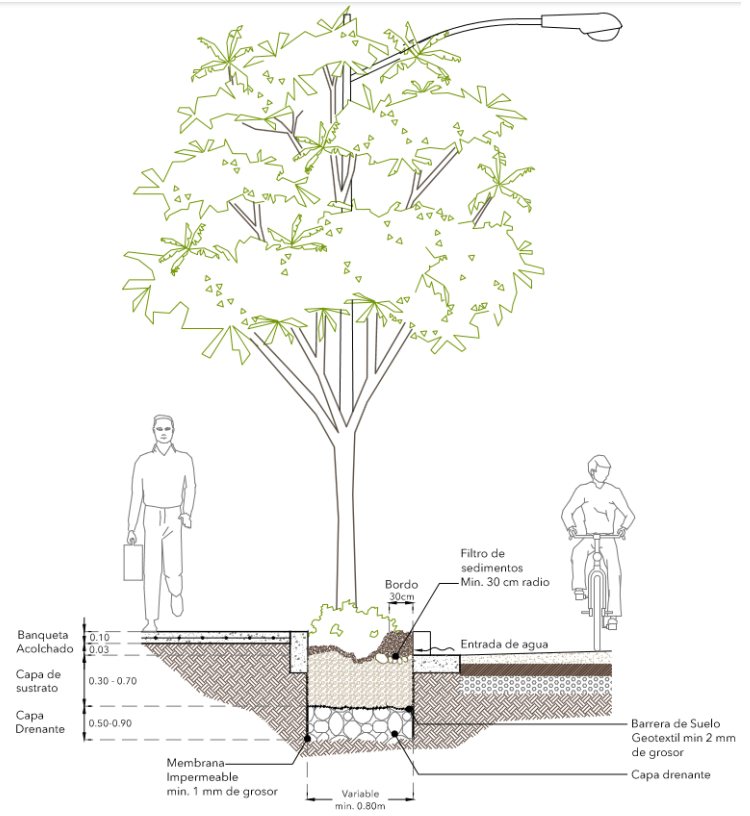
Detalles constructivos de Jardín de Lluvia.
